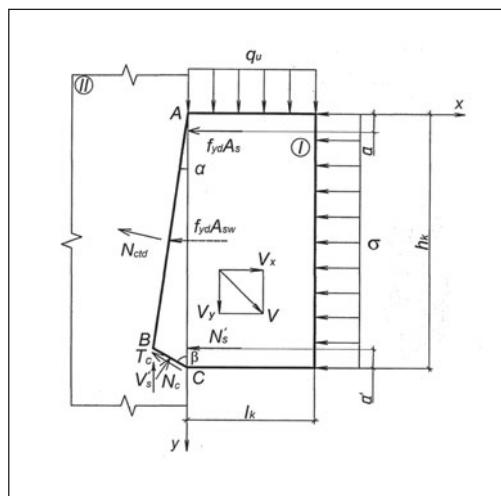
Кинематическая схема разрушения прямоугольных железобетонных (бетонных) шпонок при срезе
